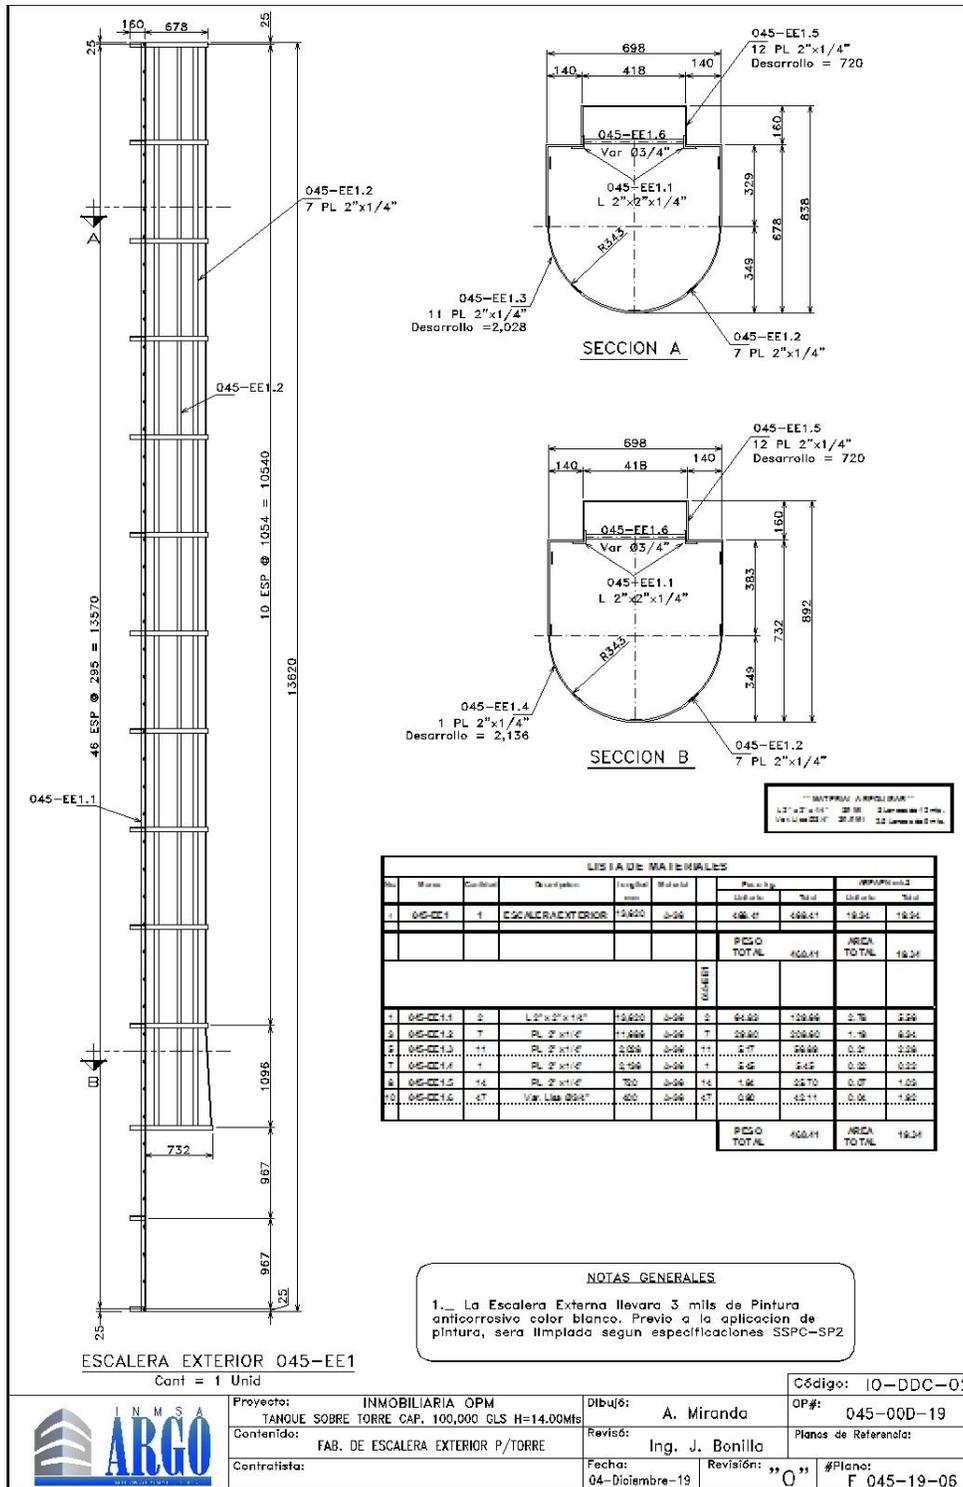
plano para la fabricación de escalera exterior para tanque elevado
